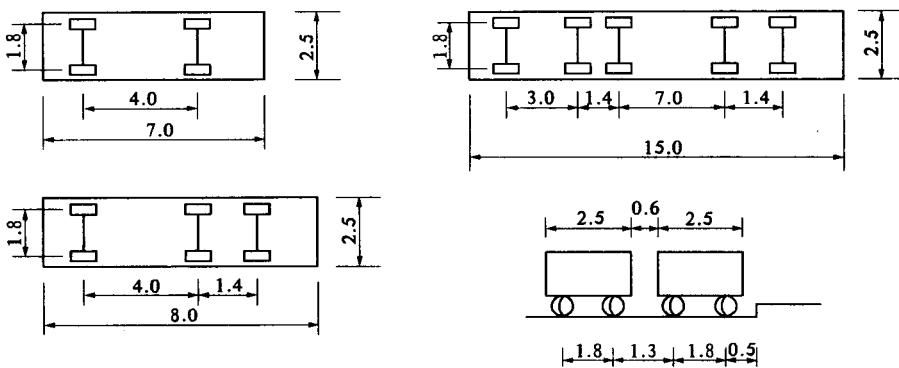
各种设计车辆的平面尺寸和横向布置图 (单位:m)
